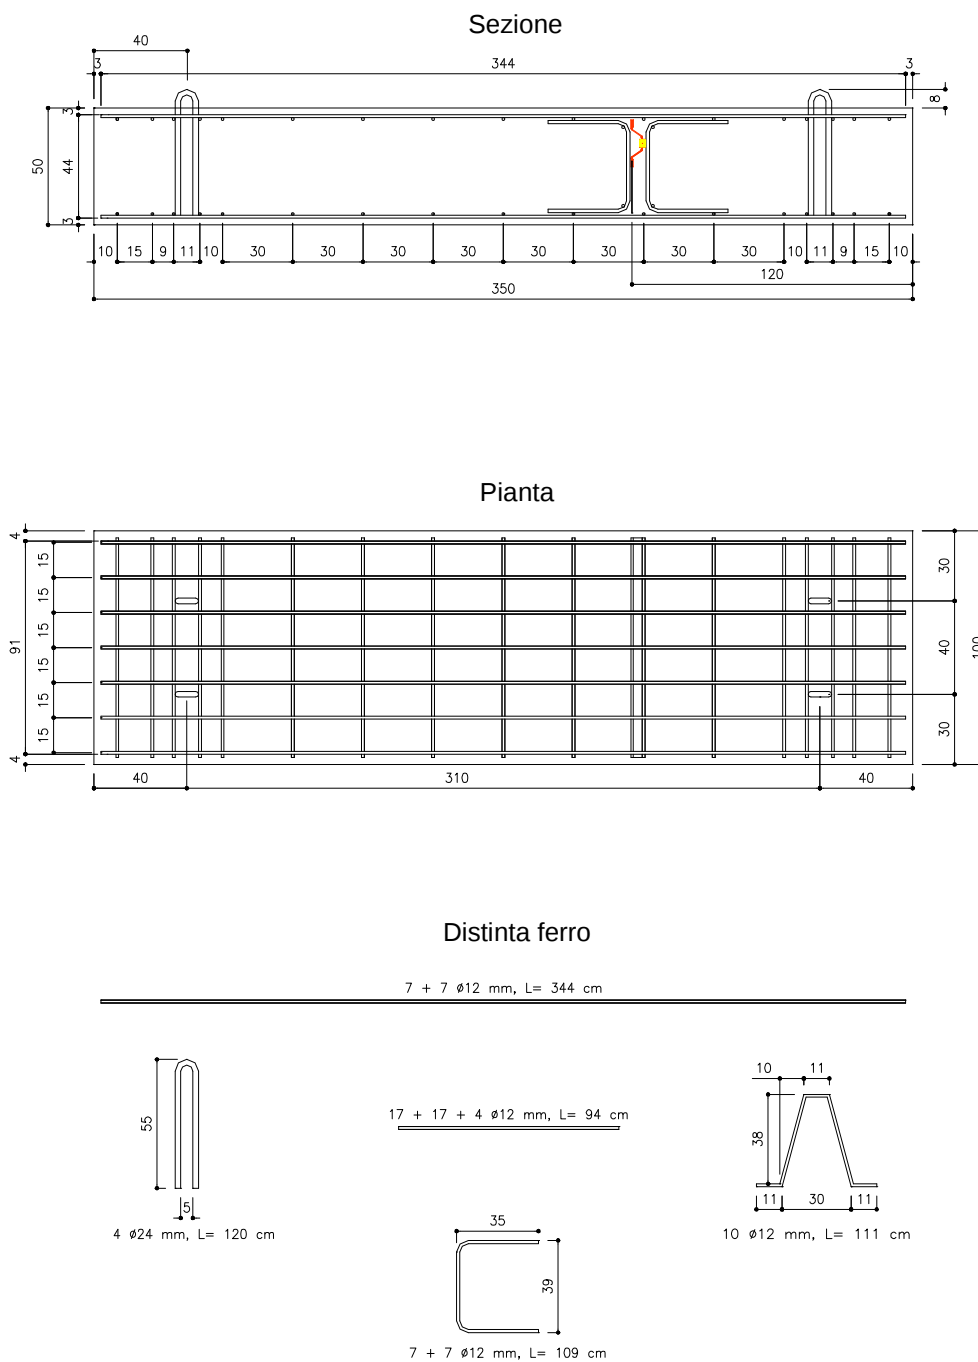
Trave DRY 2: trave con giunto “Drytech” con orientamento destro.
